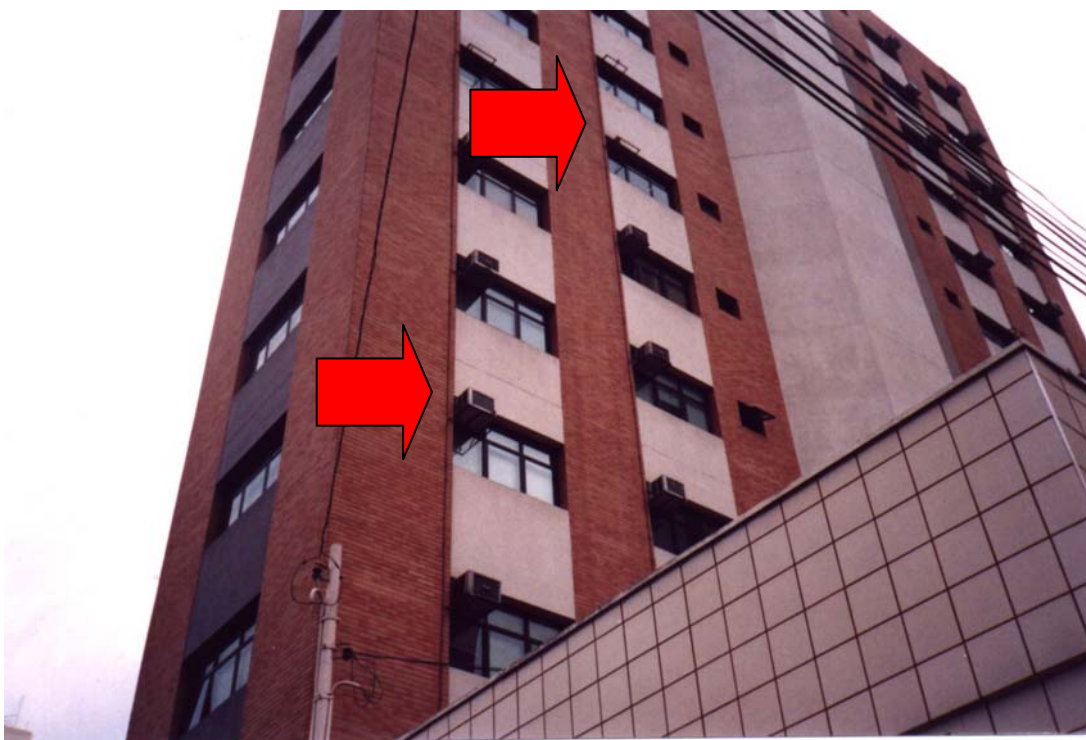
Tubulações em PVC expostas – dreno de ar condicionado
